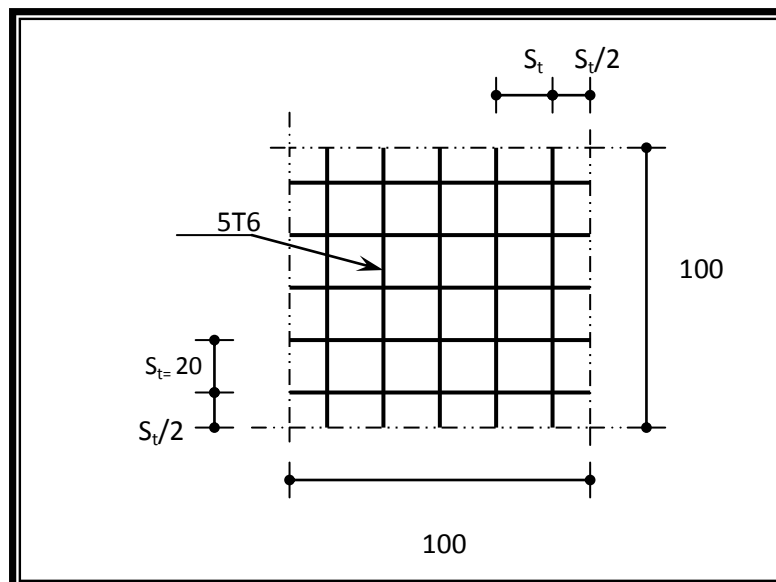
Disposition constructive des armatures de la dalle de compression
